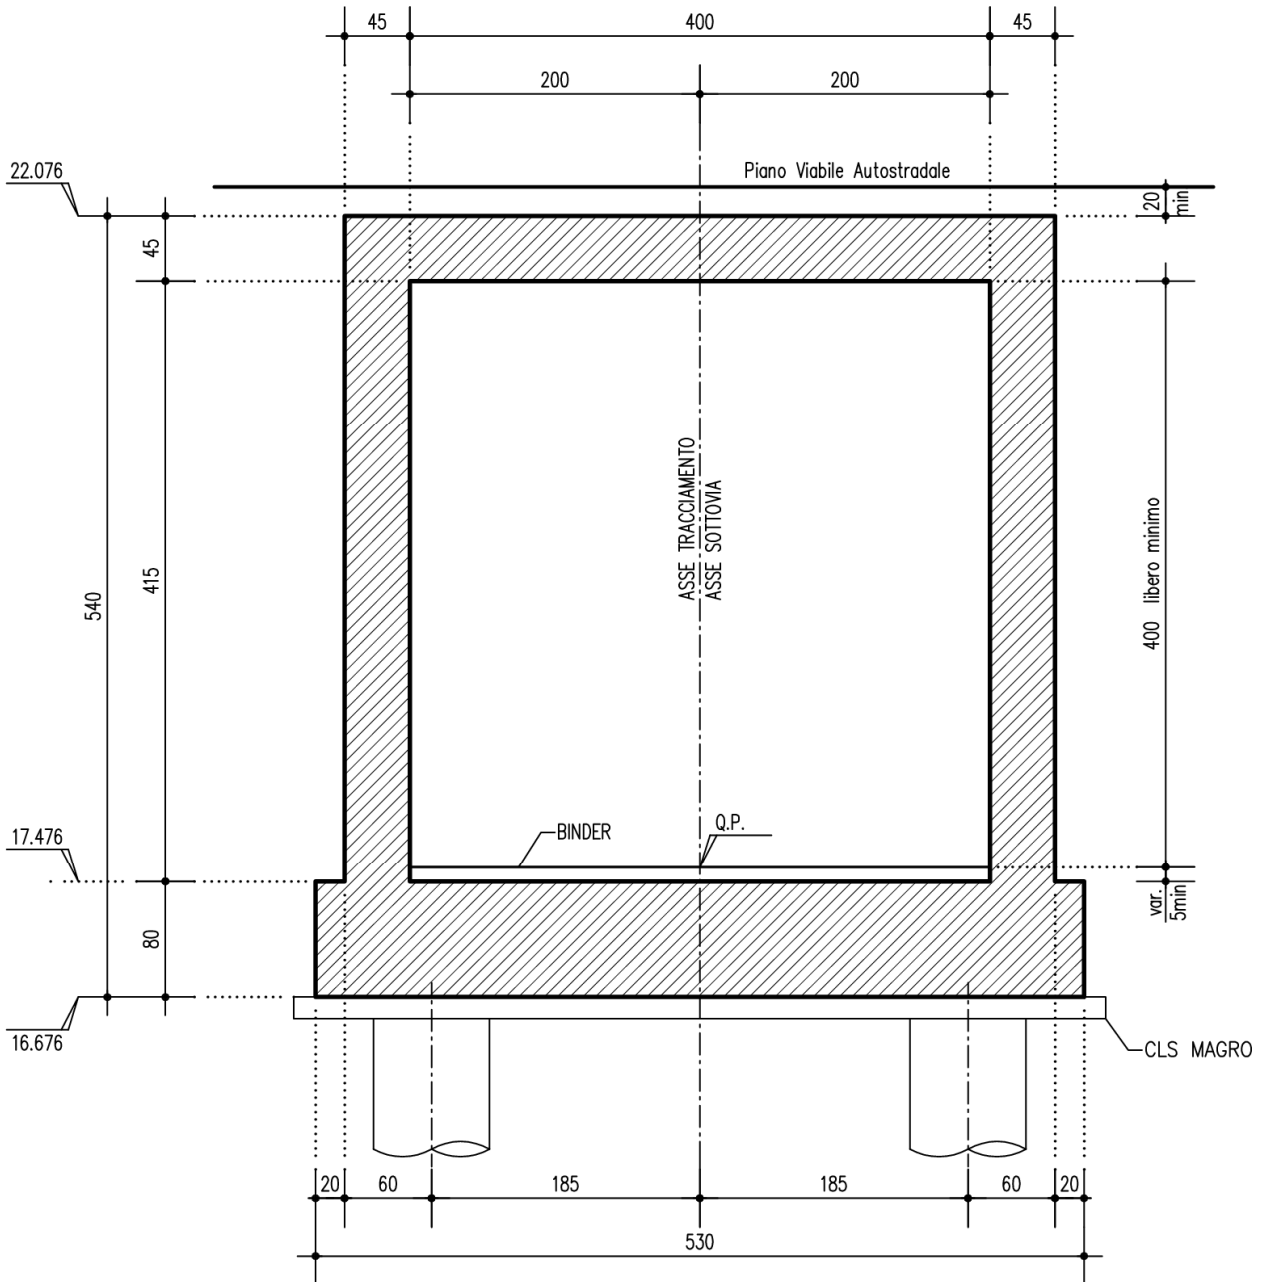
SEZIONE TRASVERSALE SOTTOVIA
